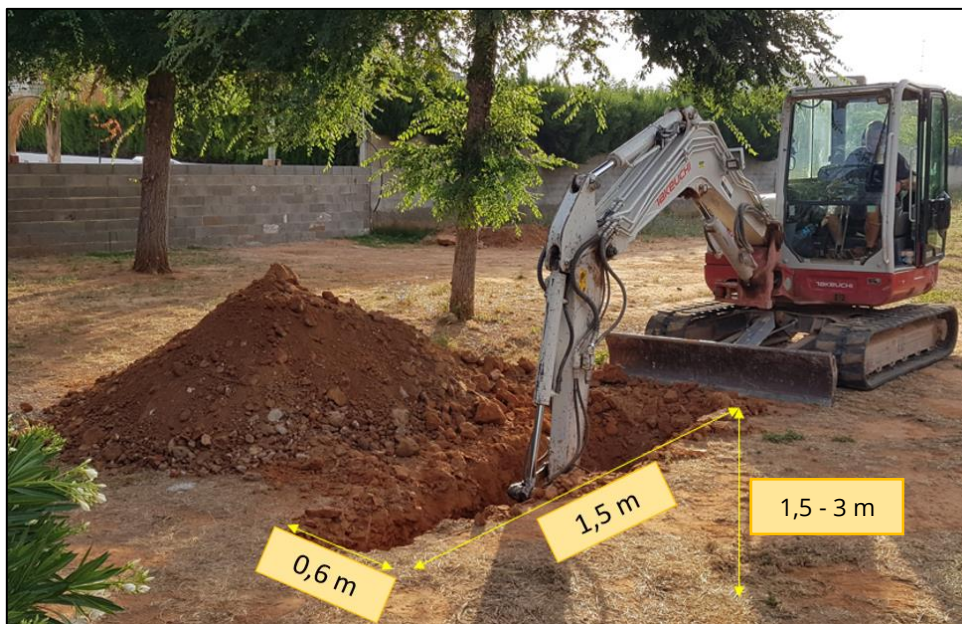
Dimensiones propuestas para las zanjas objeto del ensayo.
